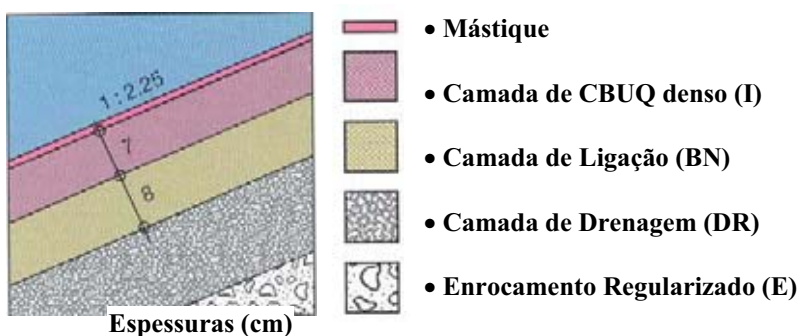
Estrutura típica das camadas da face de montante da barragem Roadford (Walo, 1997a).
